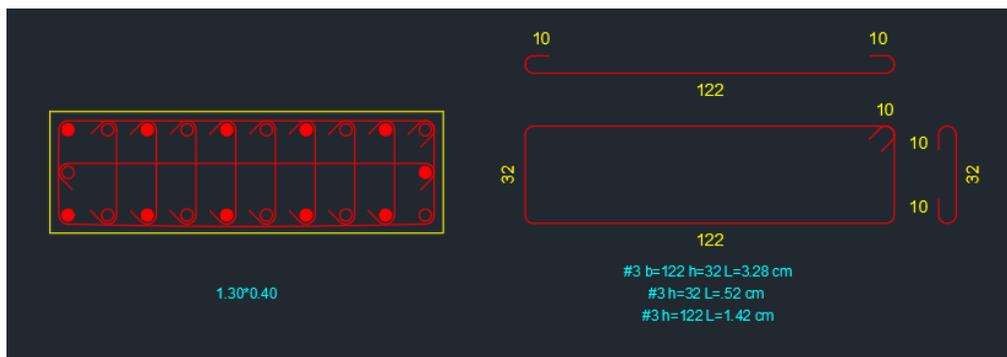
sección columna 130cmX40cm (fuente: planos estructurales Edificio Fourvière)
